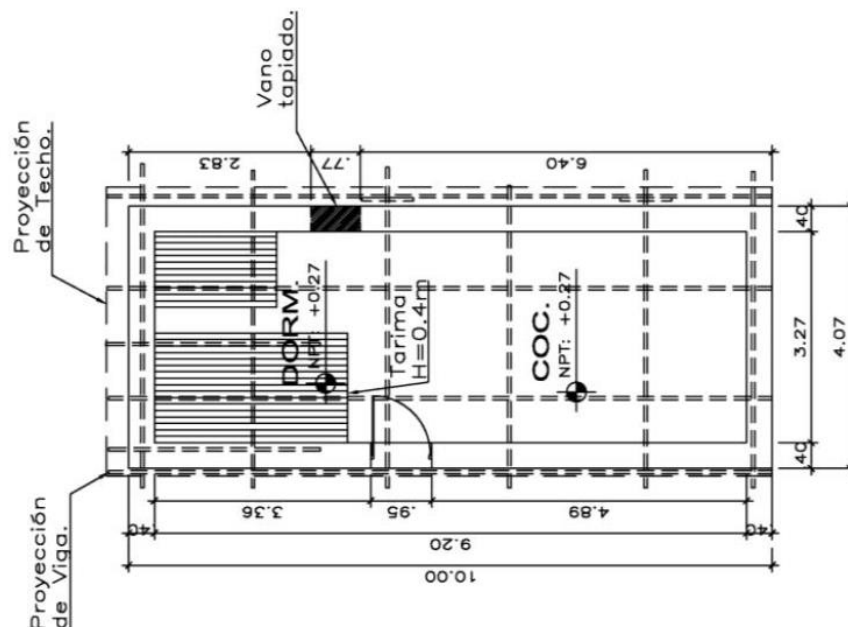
Vistas de planta de la típica vivienda rural en Huancavelica
